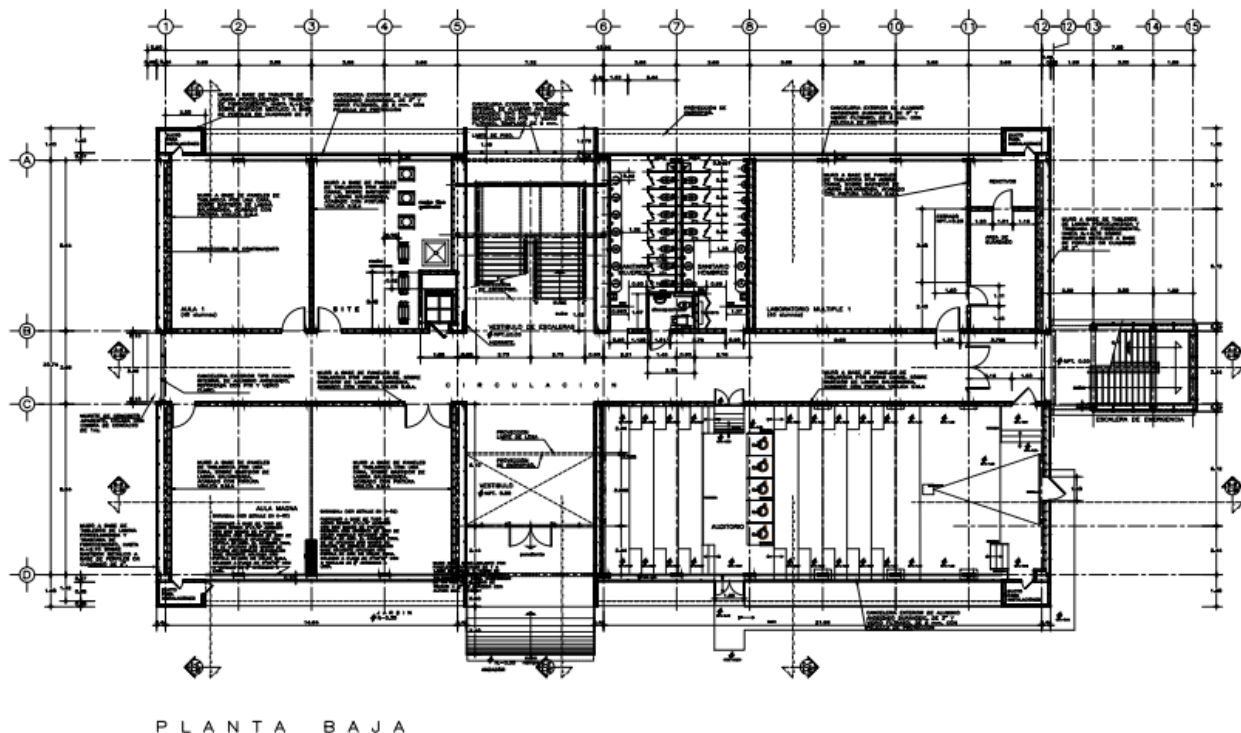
Planta baja arquitectónica. Elaborada por el autor
